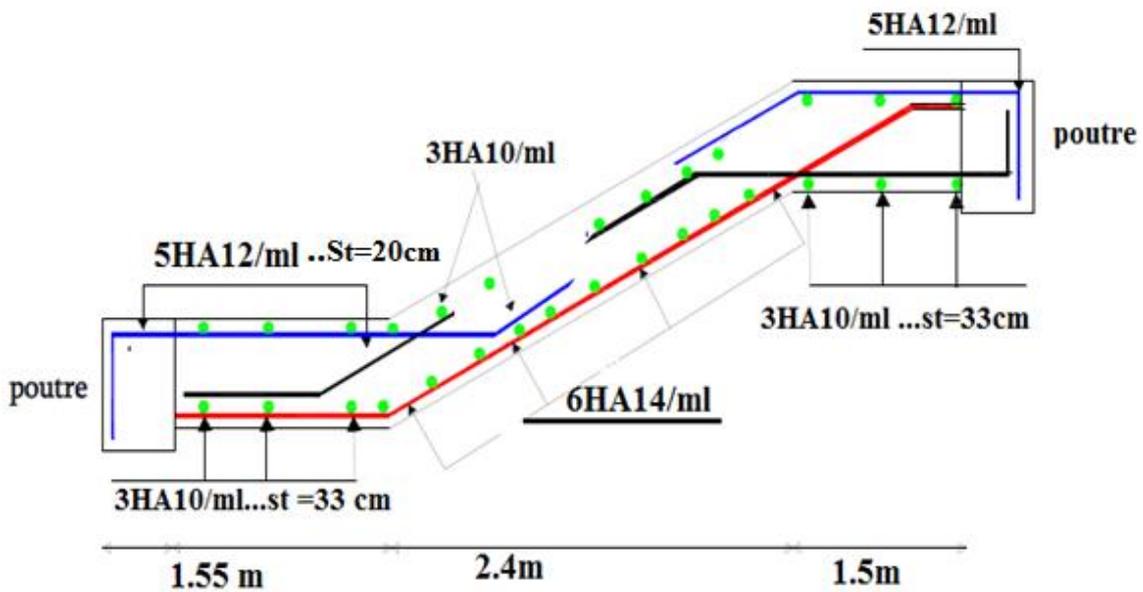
Schéma de ferrailage d'escalier du l'étage courant
